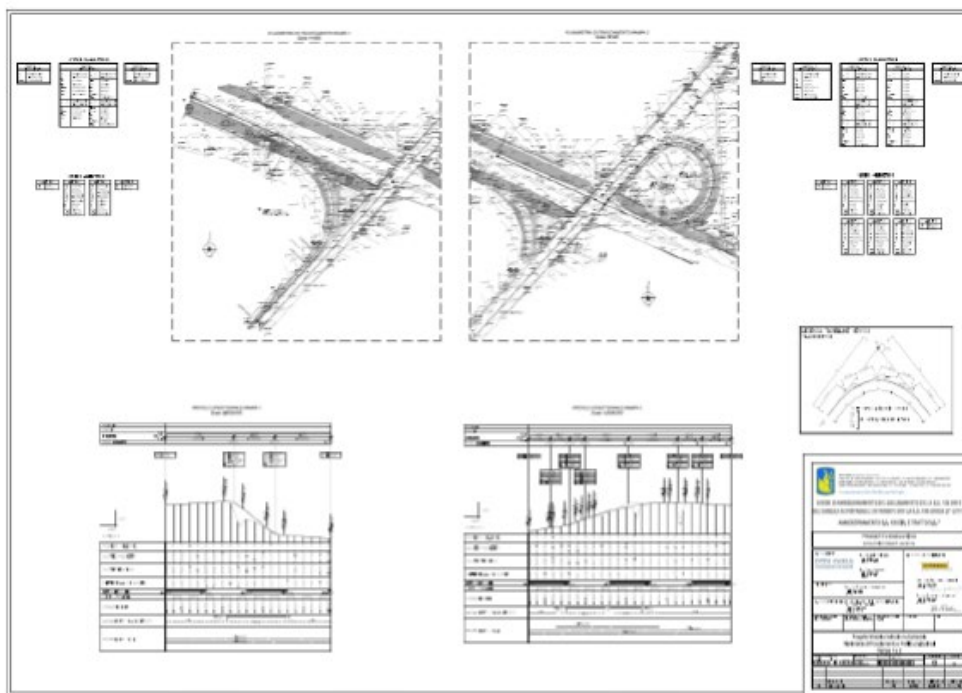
Planimetria Progetto esecutivo originario 2009
